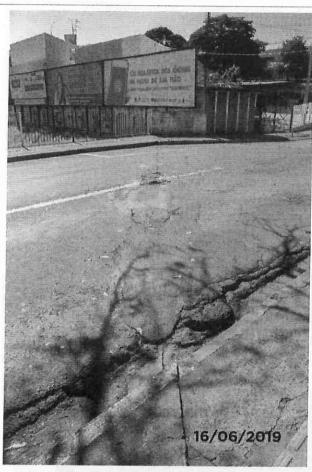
Detalhe da fissura e depressão da junta de dilatação.
